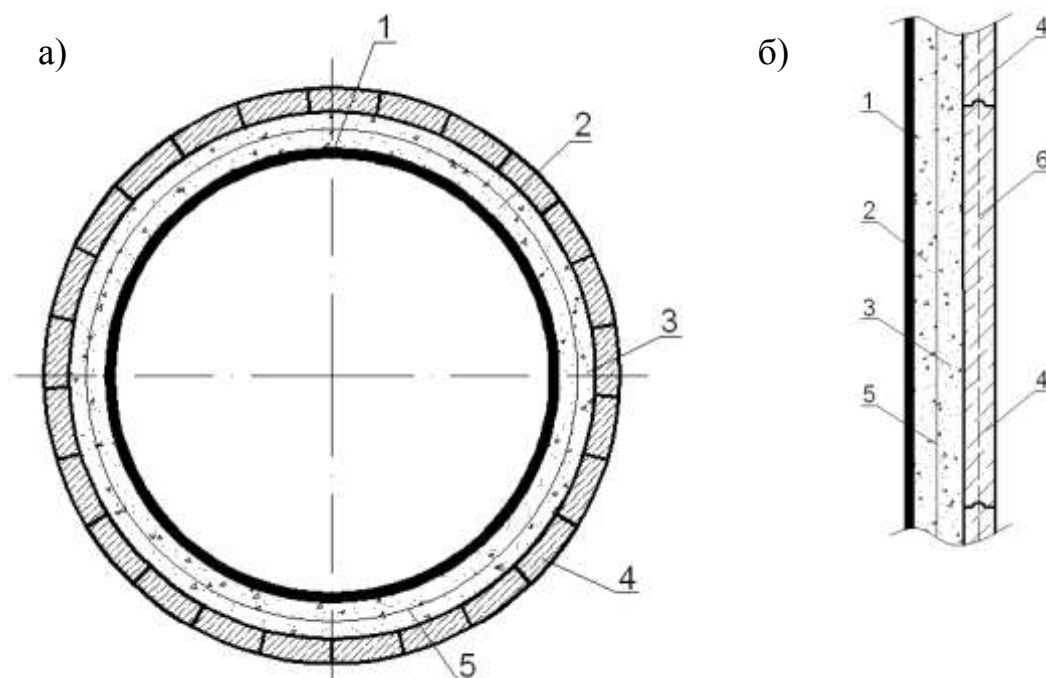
Поперечный разрез резервуара (а), фрагмент оболочки резервуара (б)
